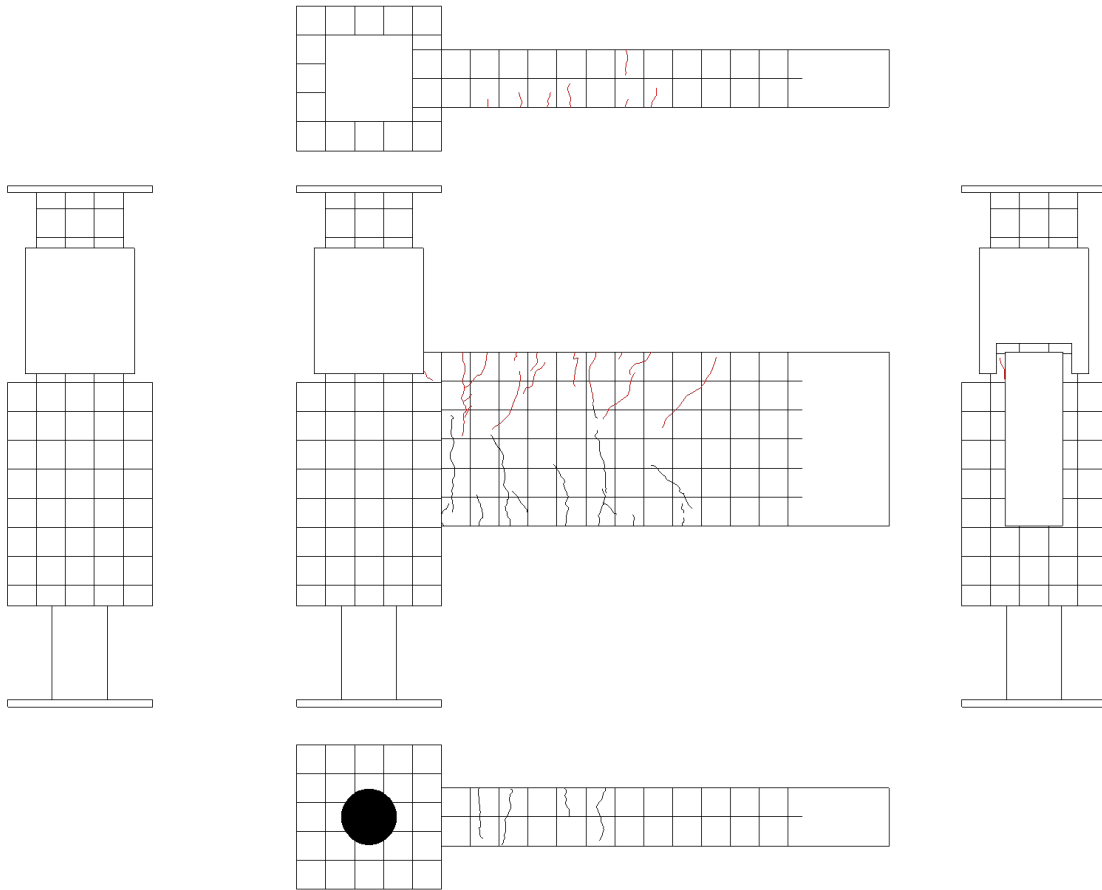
3. 54 試験体 A-2 ひび割れ状況 (10cycle)
